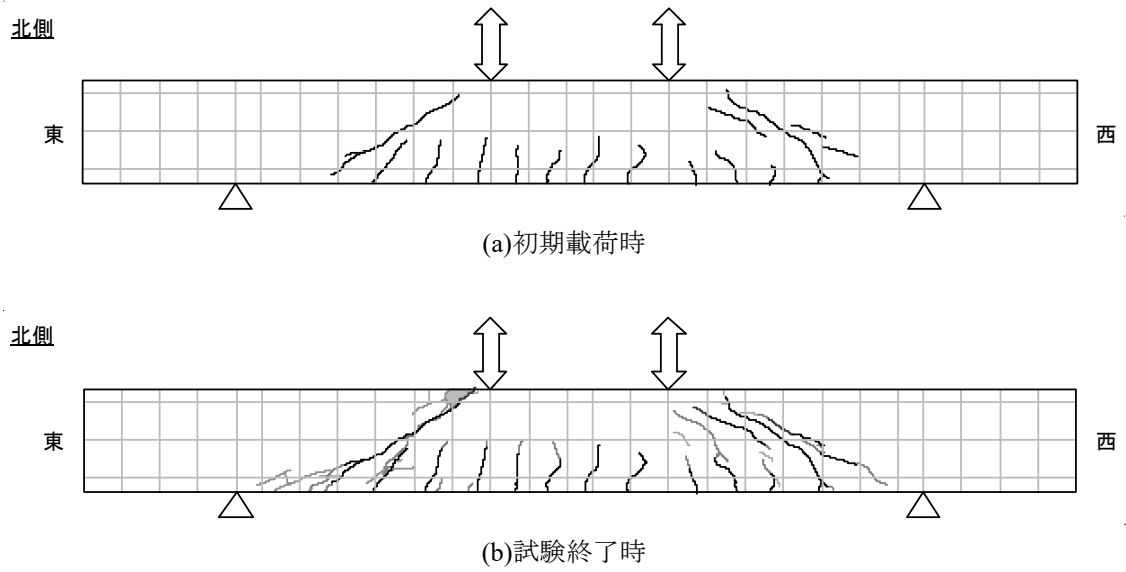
ひび割れ状況(CASE-1)
